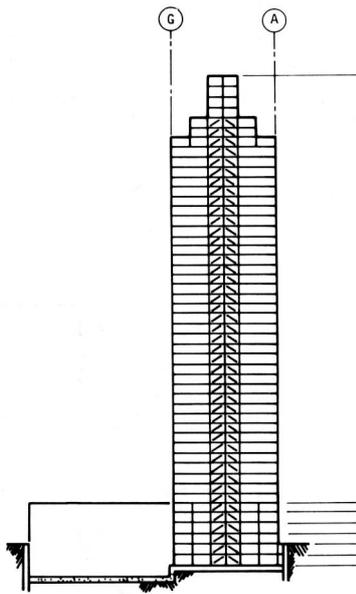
Aussteifendes Fachwerk in einem Hochhaus [59]
